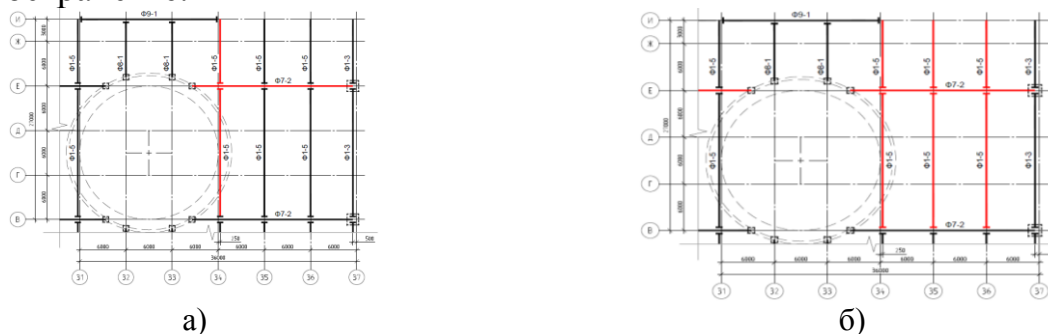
Схемы расположения ферм покрытия, требующих усиления: а) текущее НДС; б) при размещении эксплуатируемых помещений.
